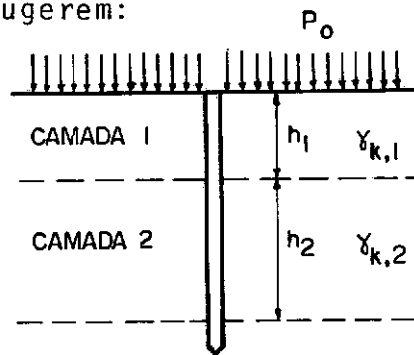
Atrito negativo em estacas cravadas em camadas diferentes (apud De Beer e Wallays, 1968).
